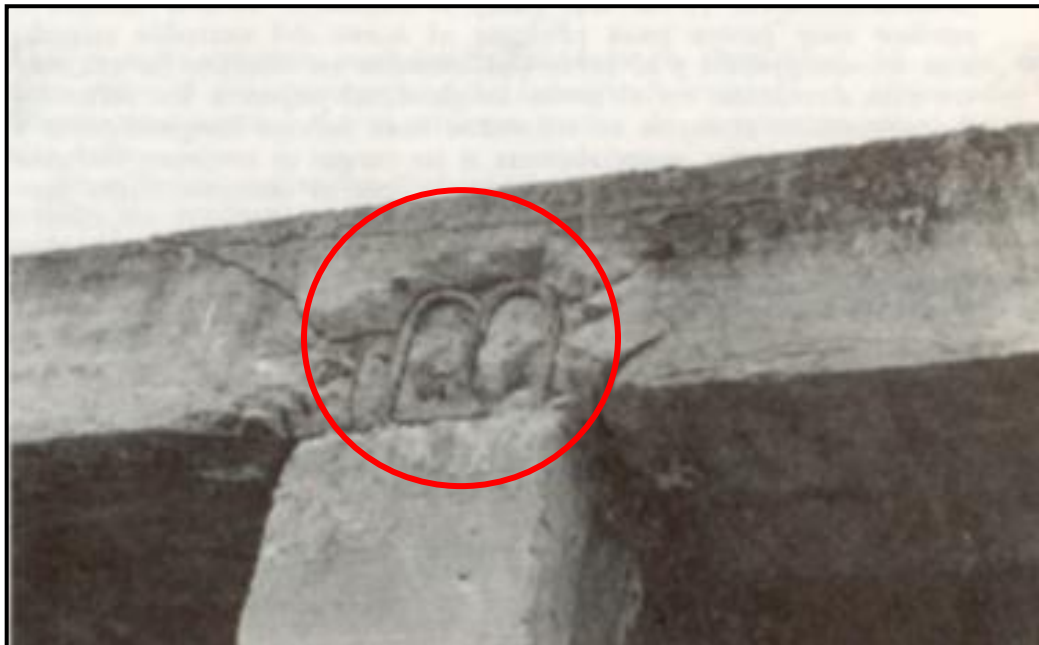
Desconchamiento del concreto en unión viga-columna
